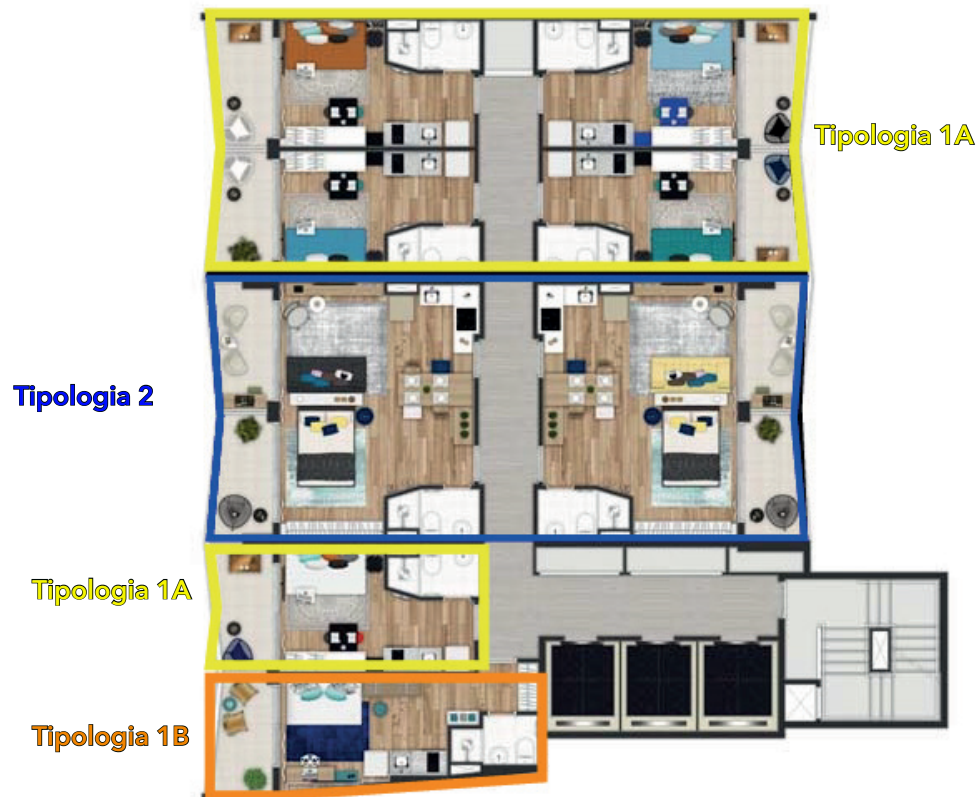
Planta de pavimento tipo SETIN *Downtown Sé*.
